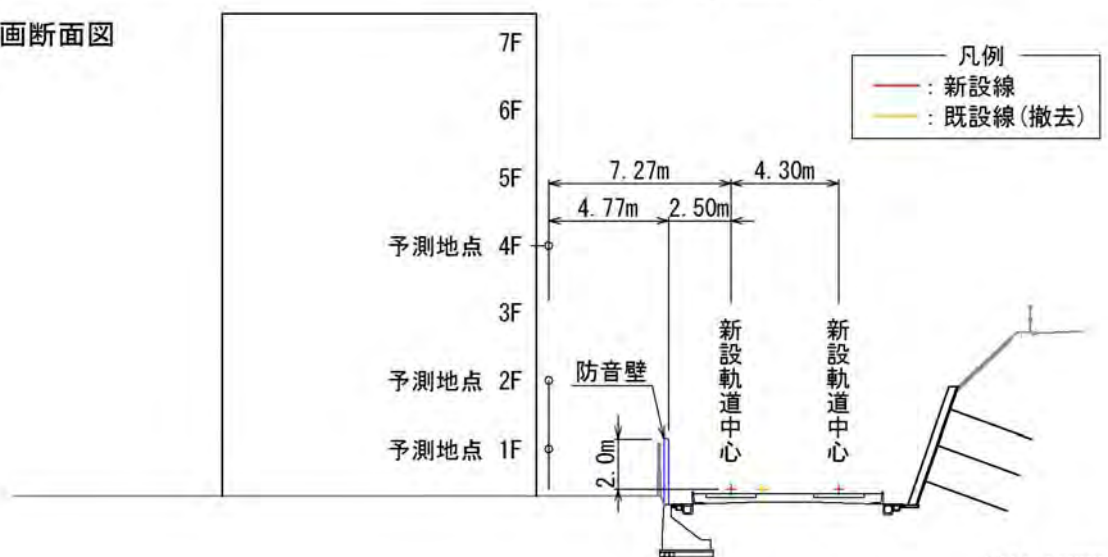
(19) 予測平面・断面図(予測地点 No. 19)
